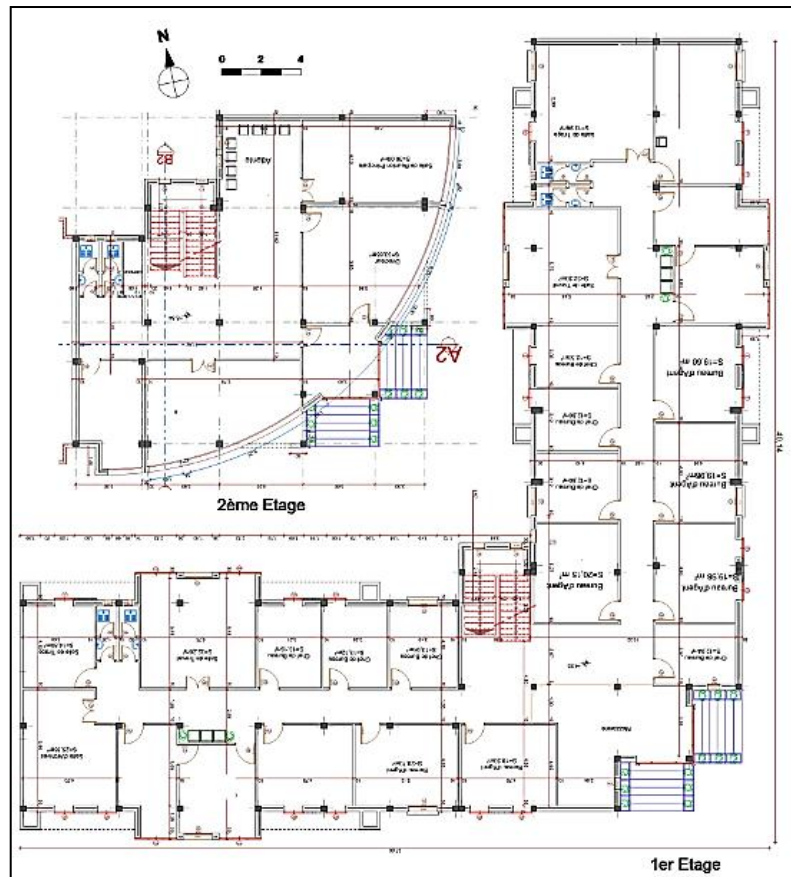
plan 1er & 2ème étage, du siège DUAC, (source : BET Top-building Bendjima).
